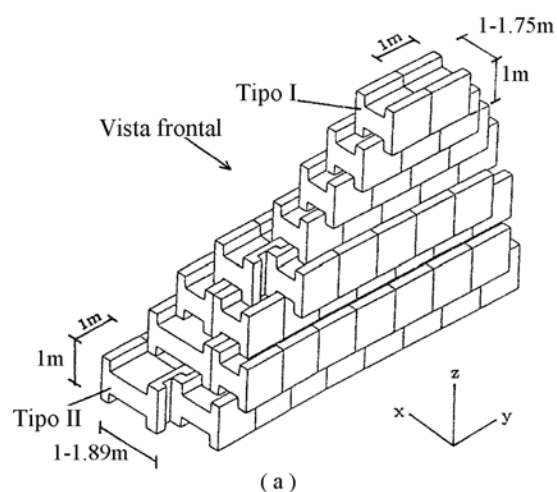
Muro de bloques de concreto propuesto por Huang, 1997.
